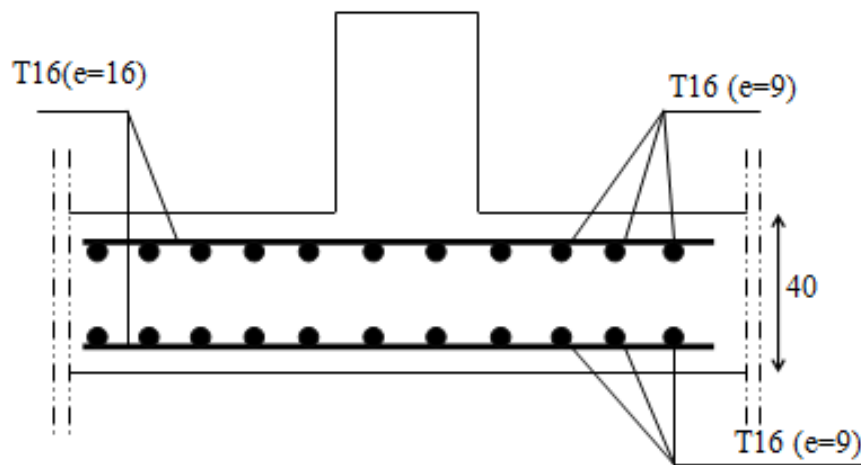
Schéma de ferrailage de la dalle du radier
